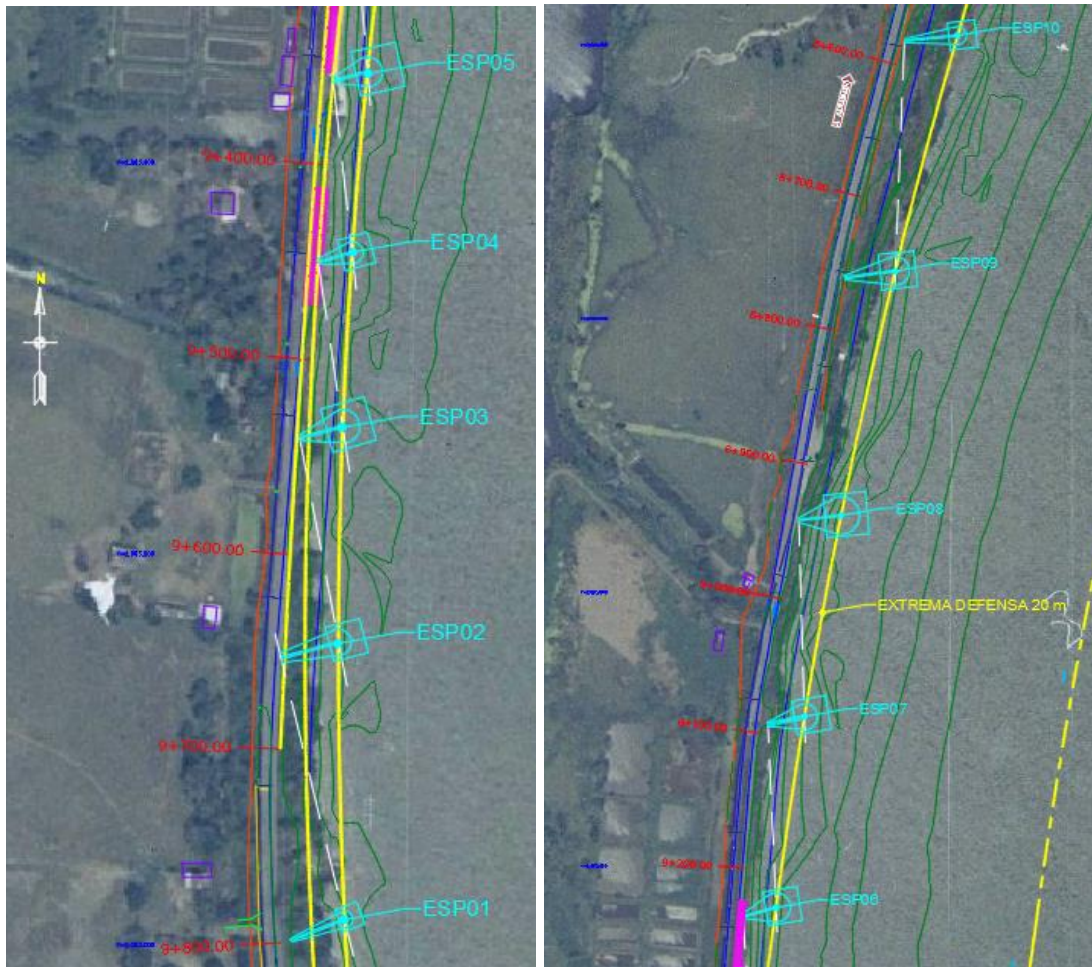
Vista en planta a detalle del arreglo de espigones como protección marginal para alejar las líneas de corriente a una distancia de 20 m.
